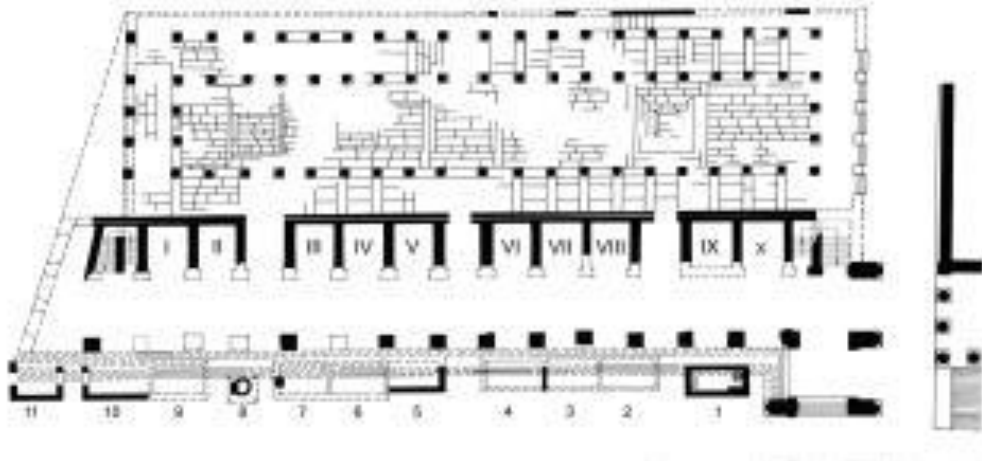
Abb XXII: Grundrissplan der Basilika Aemilia;
